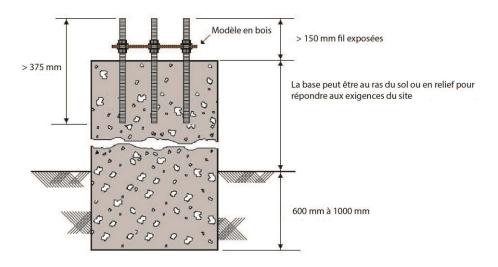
4. Boulons d'ancrage de longeur minimum 375 mm de pénétration dans le bloc de fondation
